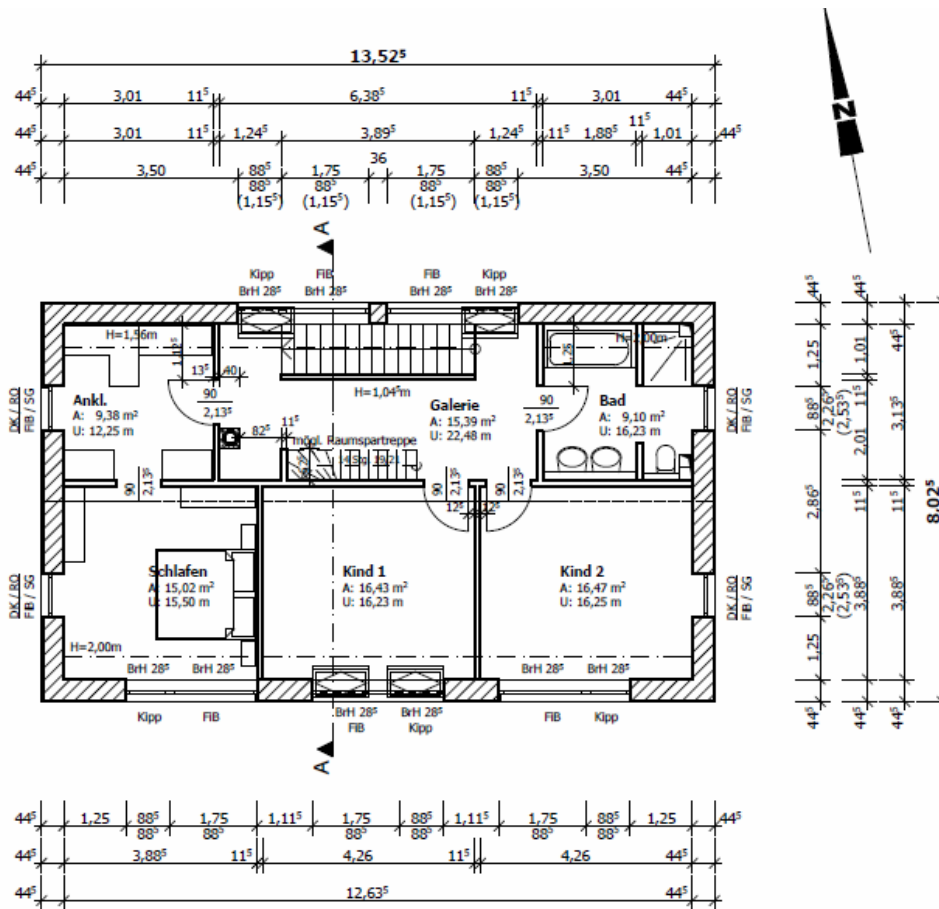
Grundriss OG des Experimentalhauses
